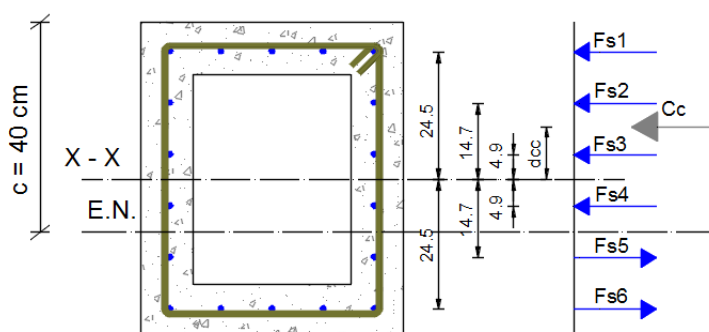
Esquema general de deformaciones, esfuerzos y fuerzas en la sección transversal rectangular
